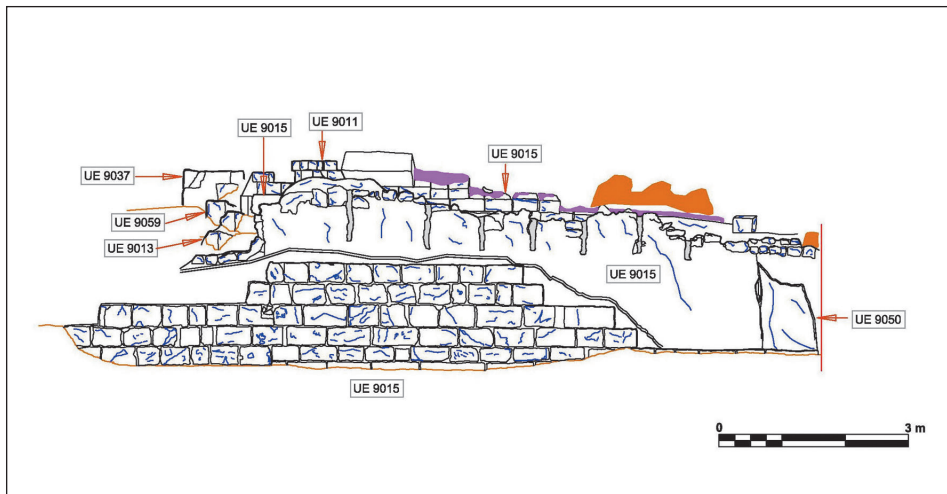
Alzado norte: muro oculto por estructuras posteriores.
